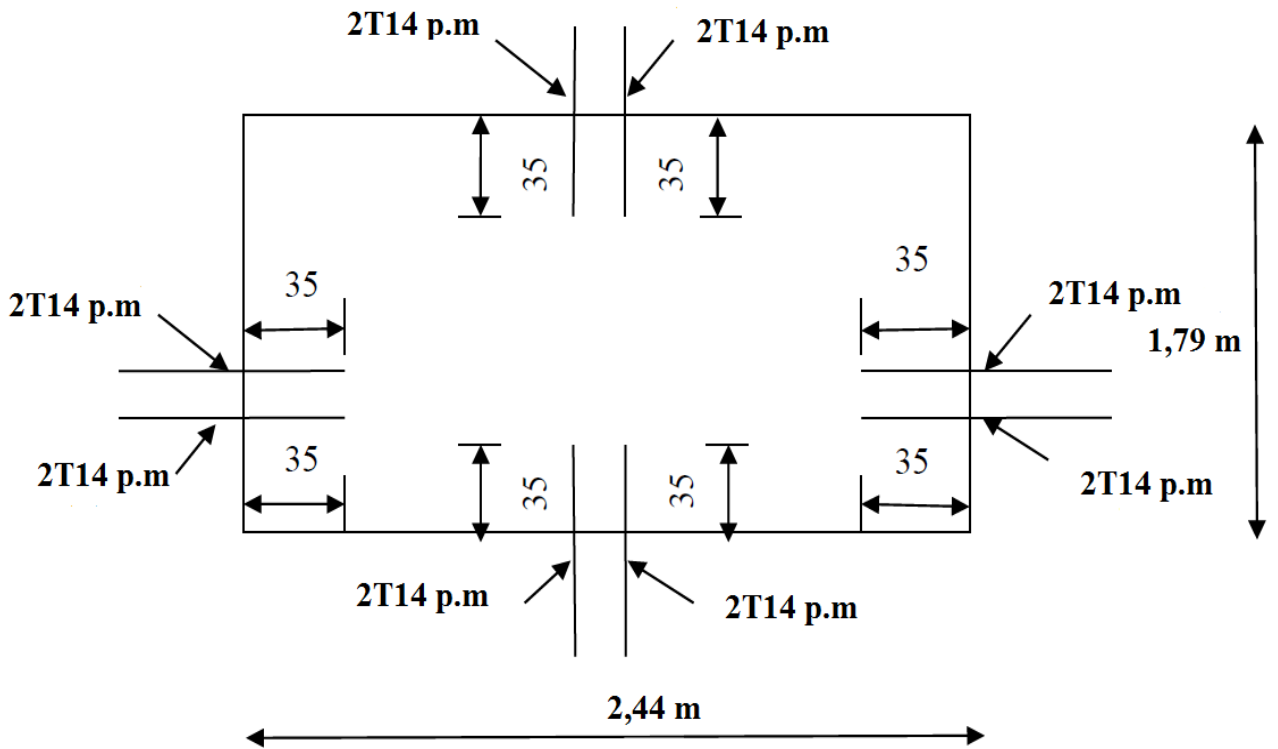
Ferrailage de la dalle balcon sur 3 cotés
